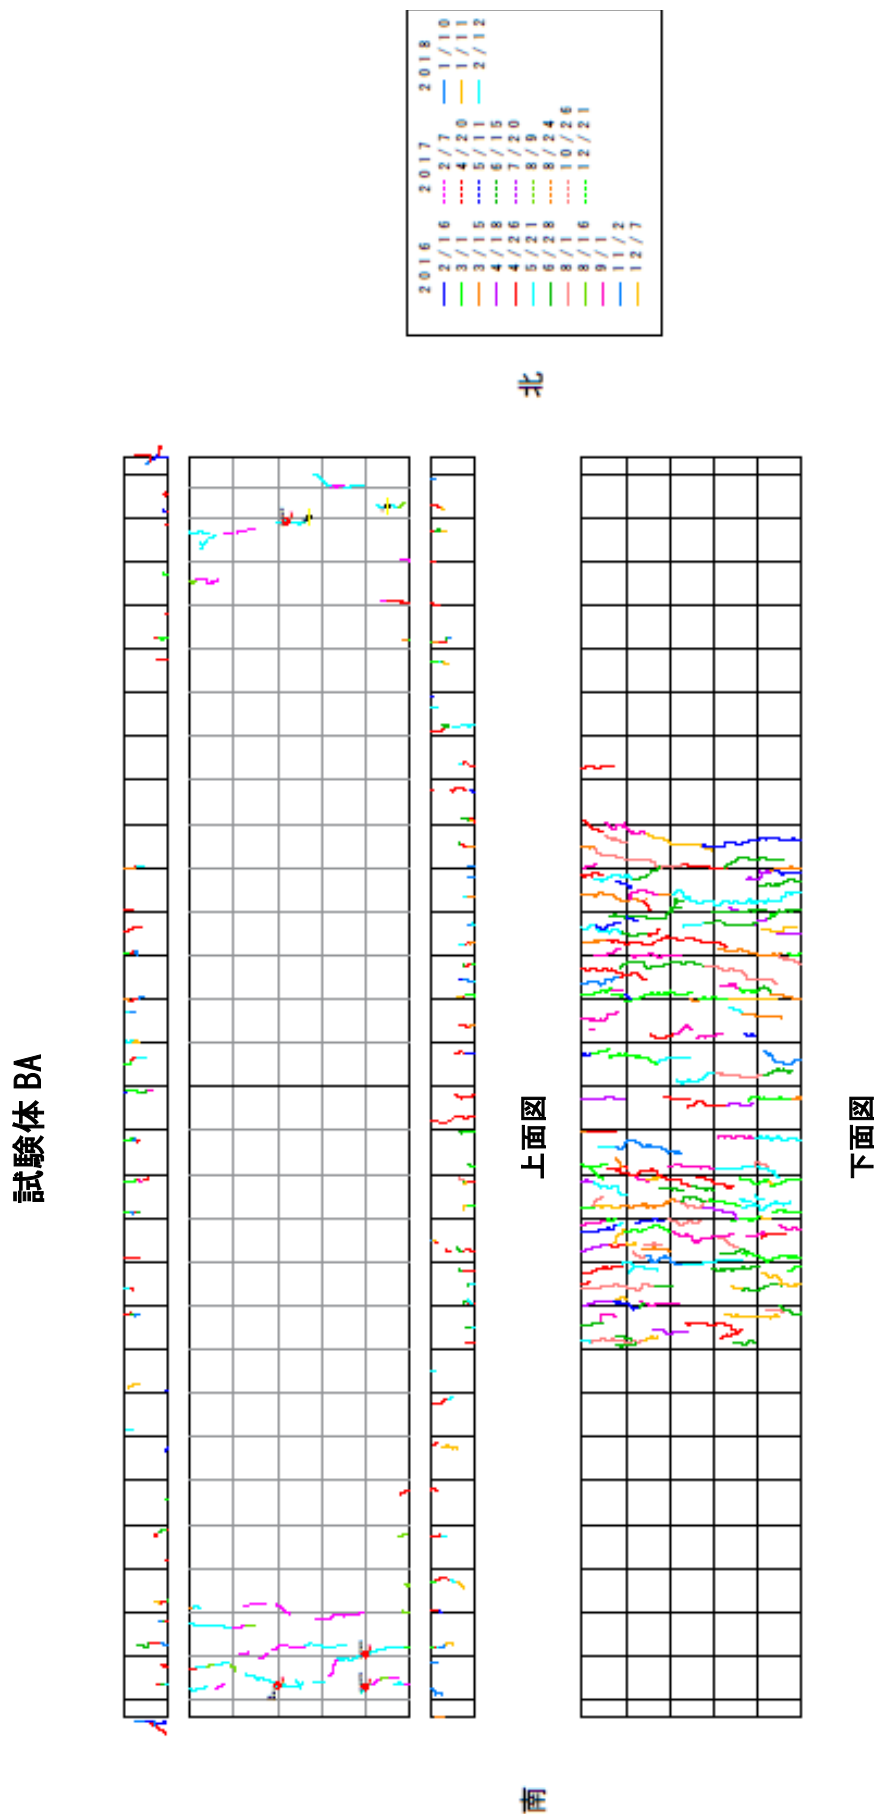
試験体 BA ひび割れ図
